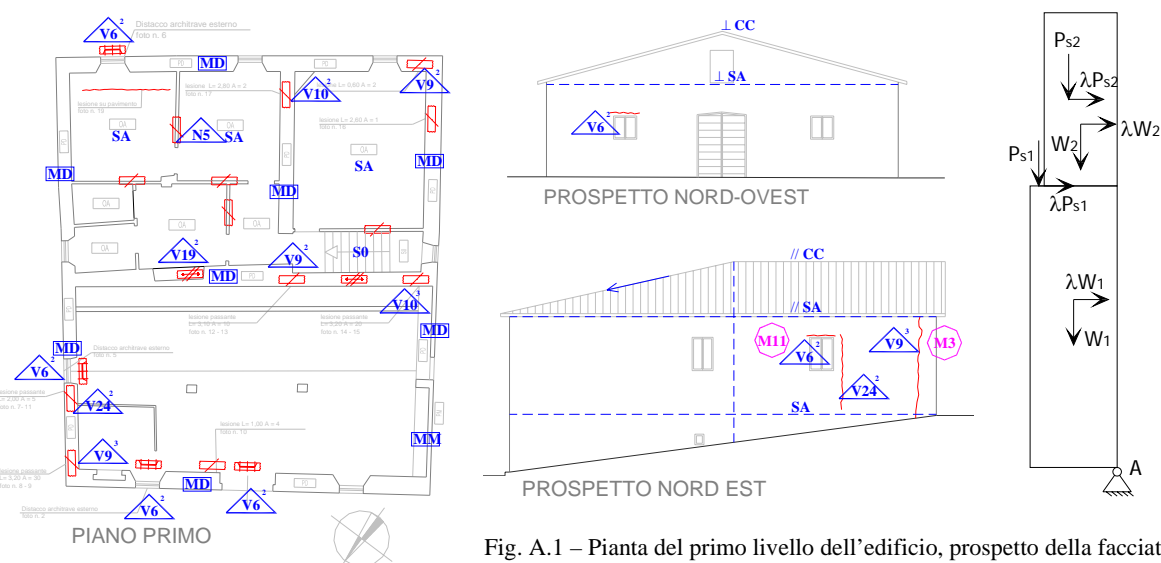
Piano del primo livello dell'edificio, prospetto della facciata ribaltante e di quella ad essa ortogonale, e schema di calcolo
